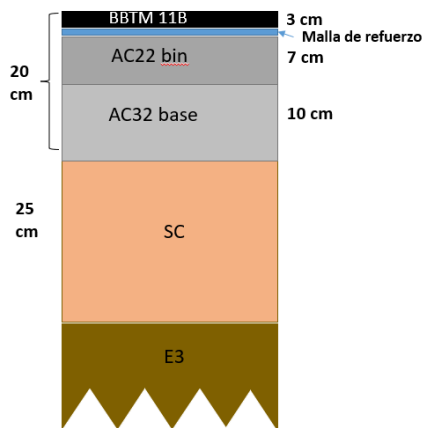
Esquema de sección de refuerzo GEO. Fuente: Elaboración propia.
